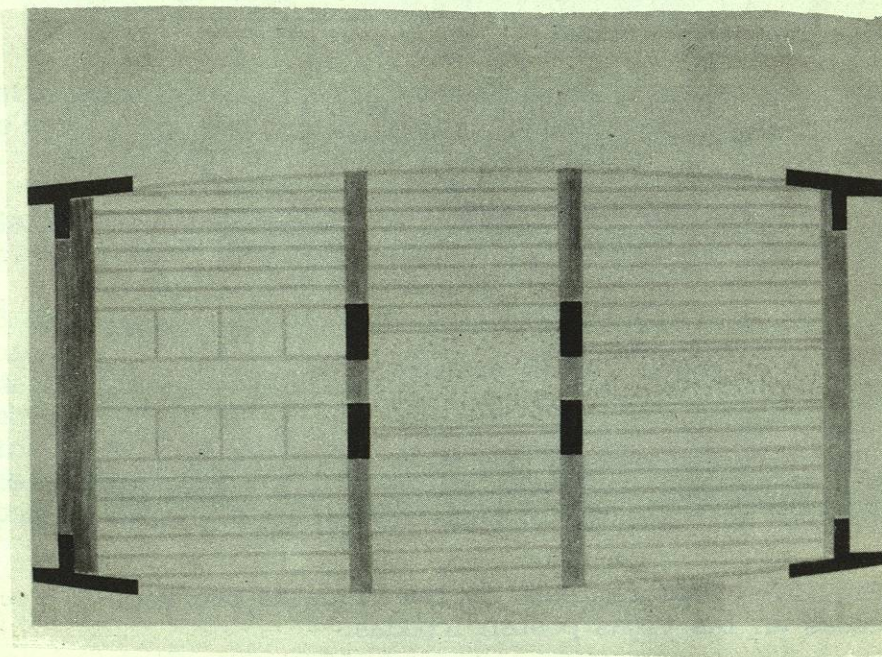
Sistema B. Pisos típicos que muestran 4 vigas postensadas soportando viguetas prefabricadas y pretensadas.
